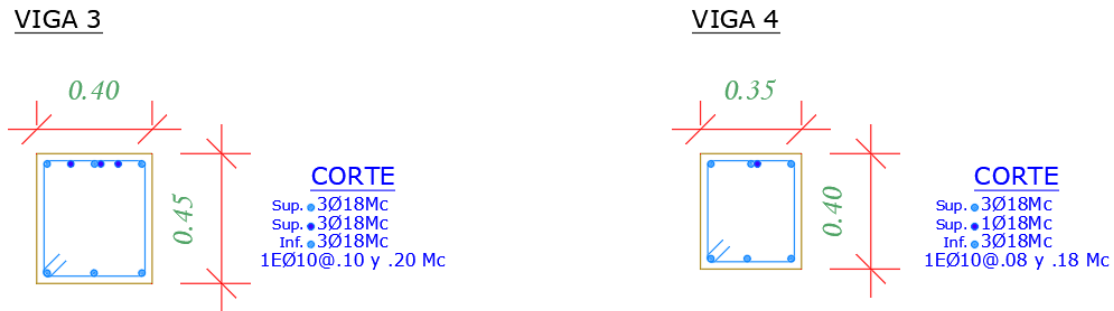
Secciones transversales de las vigas utilizadas en un edificio de 4 pisos para $\Delta_M = 2.0\%$
